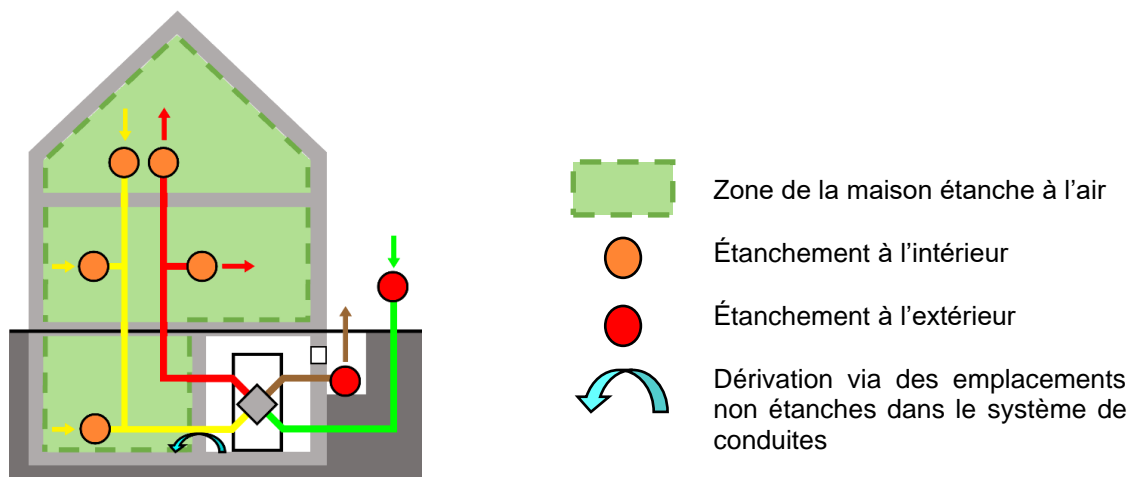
Étanchements provisoires possibles pour les installations de ventilation
